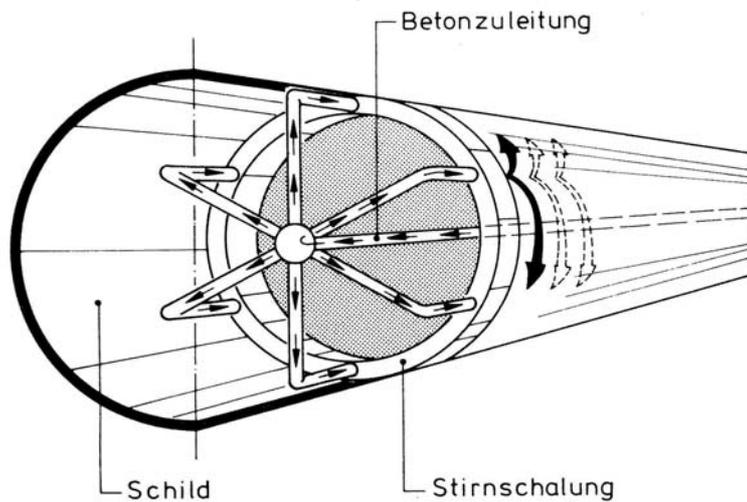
Betonzuführung beim Extrudierverfahren (Barbendererde, S., 1985)
